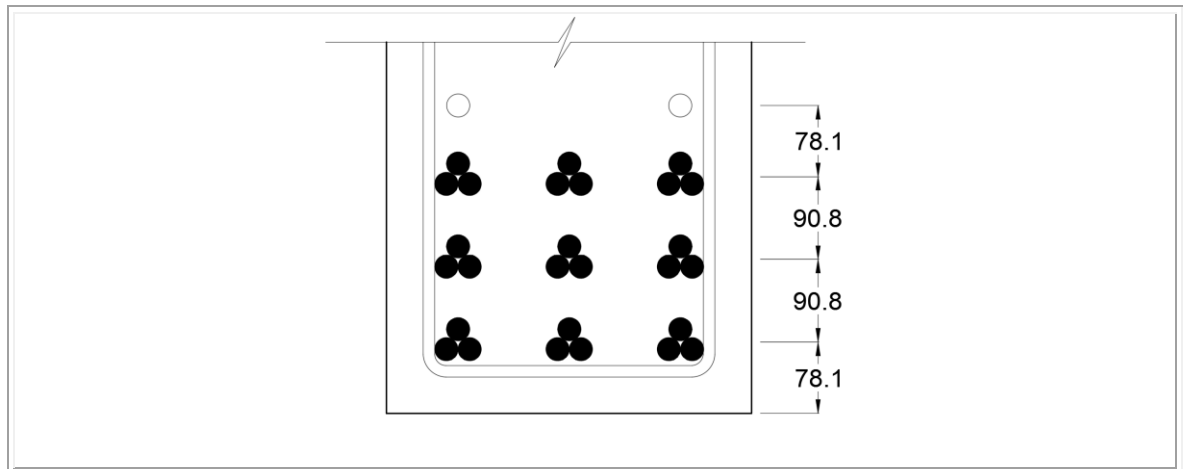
Centroide del refuerzo en el centro de la luz para 29 barras
